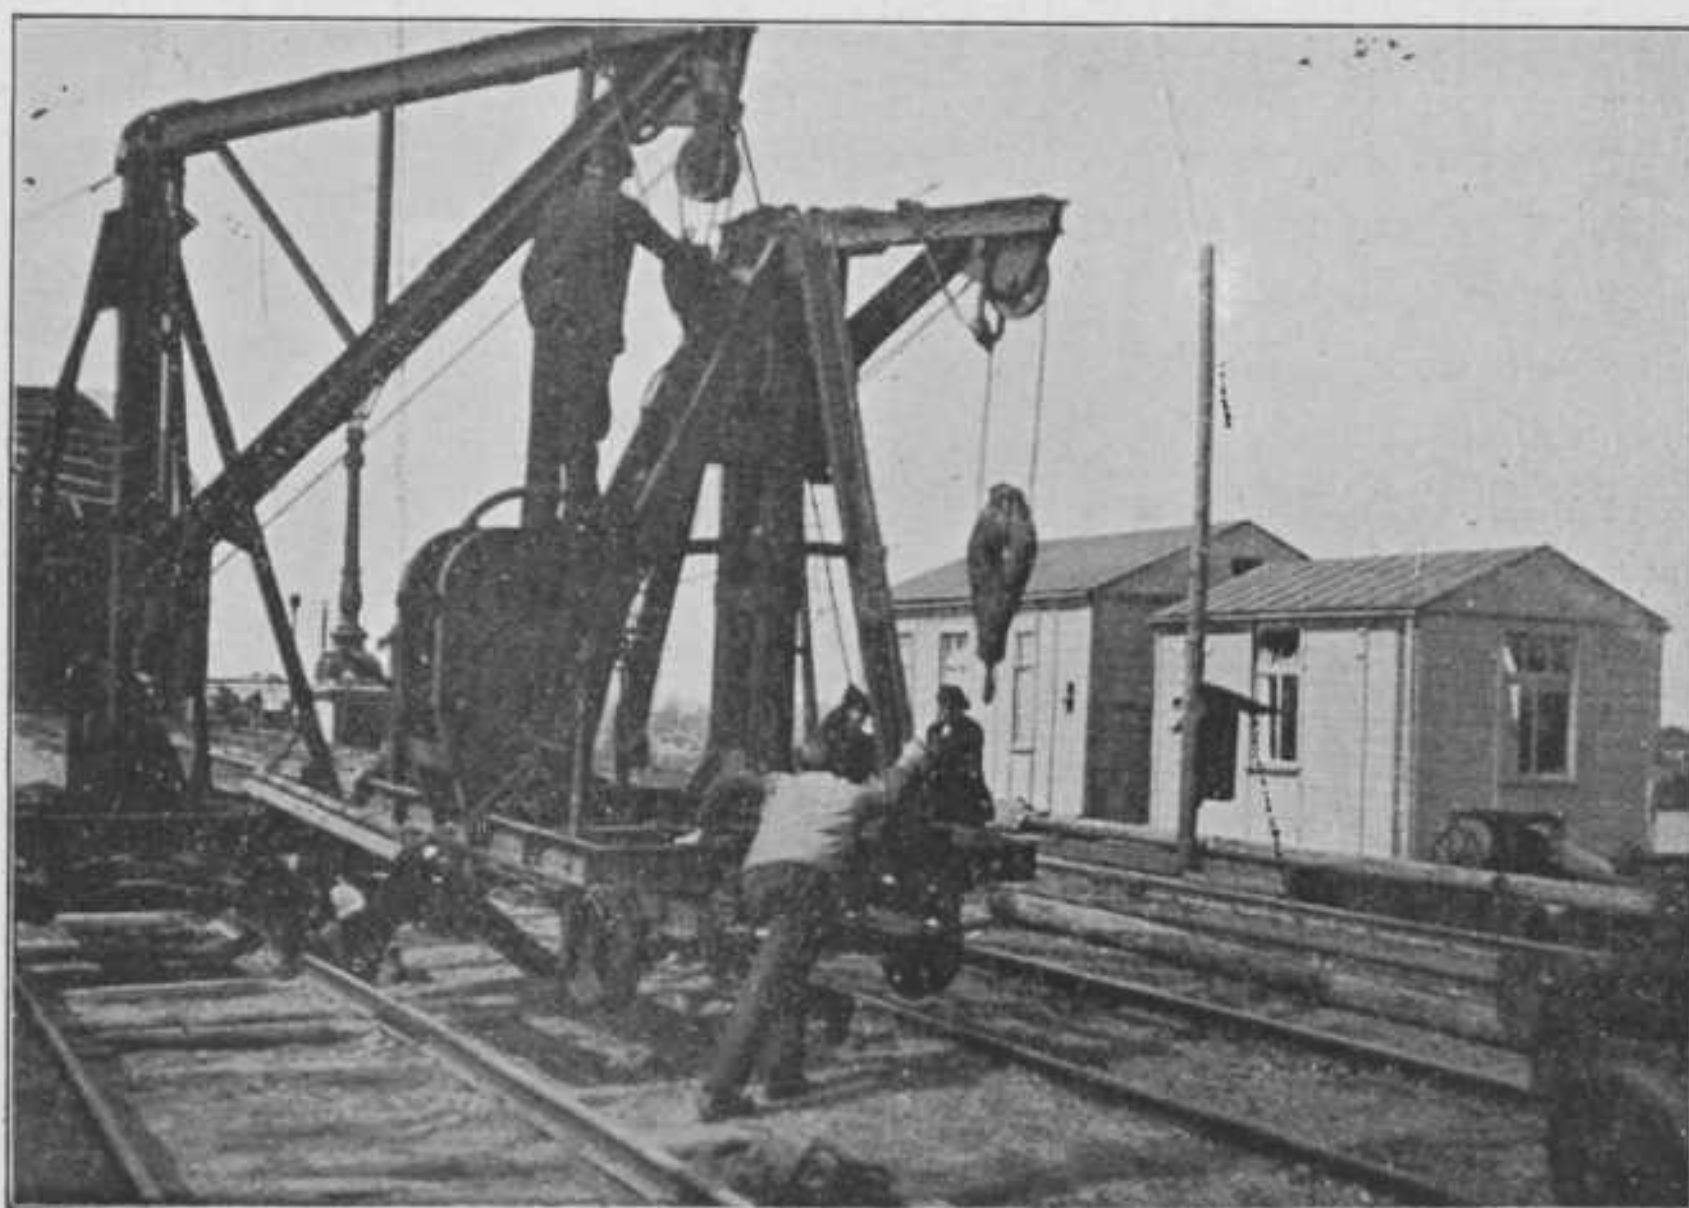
Foto I. De kleine kraan wordt door de groote in het hoofdspoor gezet.
